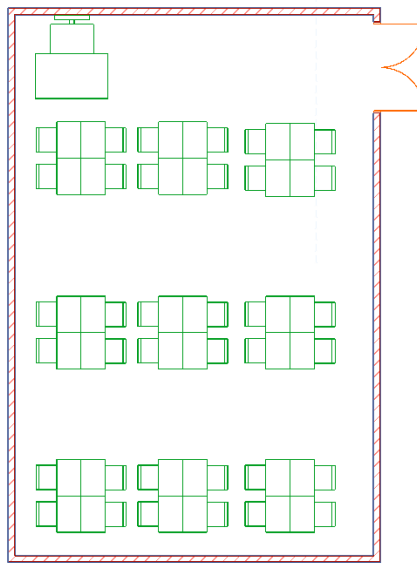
Alternatif B Konsep Layout Ruang Kelas *Collaborative
